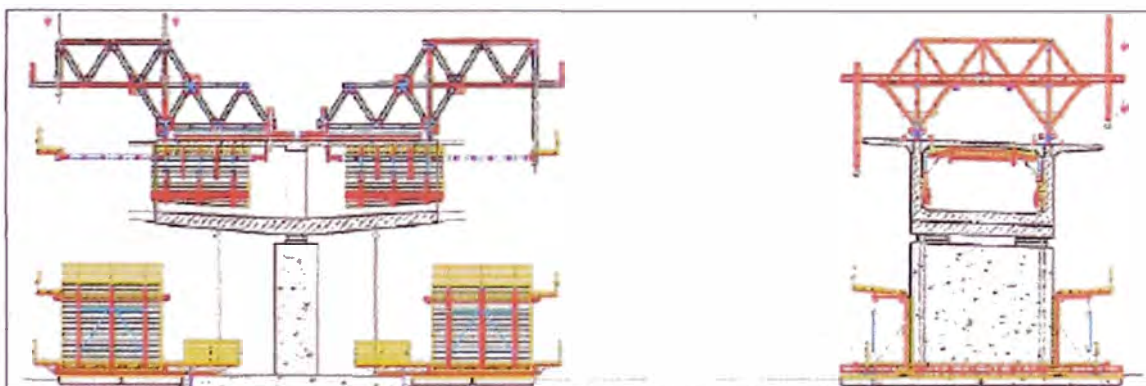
Esquema de lugar de pre montaje de encofrado de fondo.
